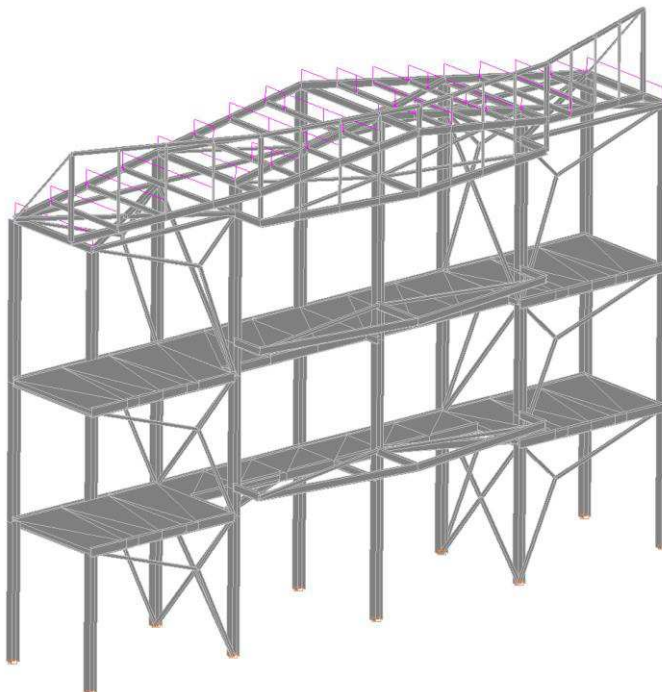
Нагрузка на каркас от снеговой нагрузки
